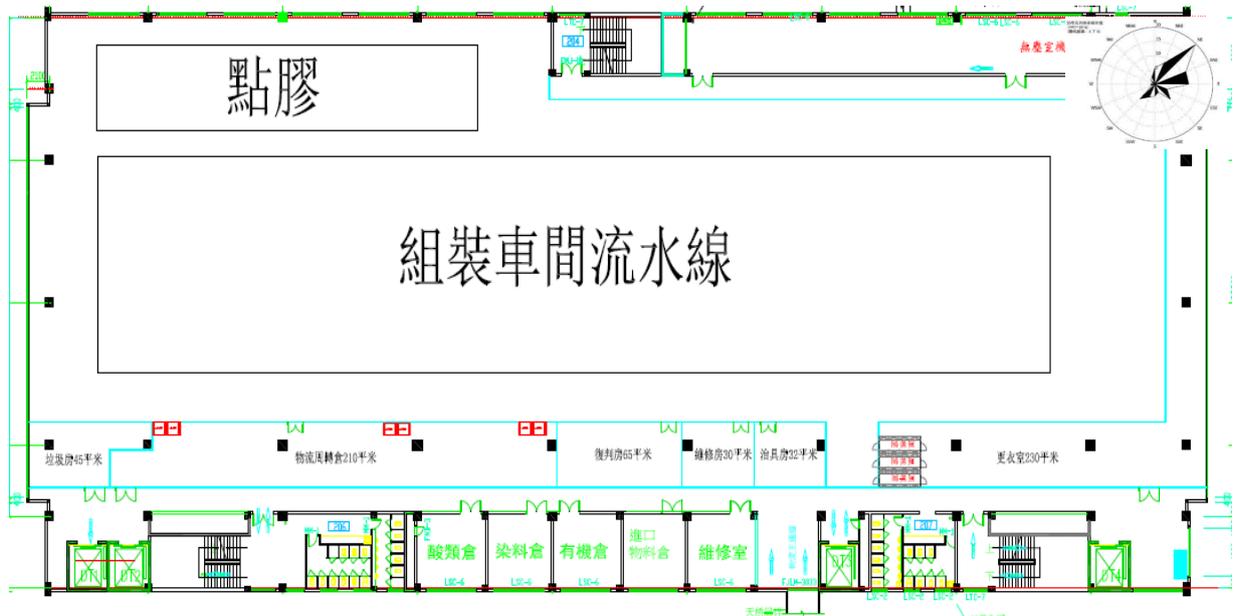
项目G4区厂房1栋1层C区车间平面布置图
